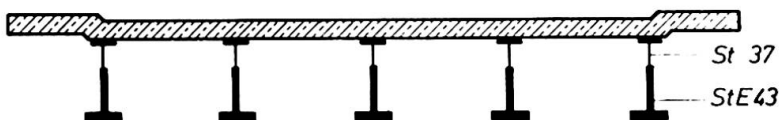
Stahlverbundbrücke mit Hybridträgern aus hochfestem Baustahl
